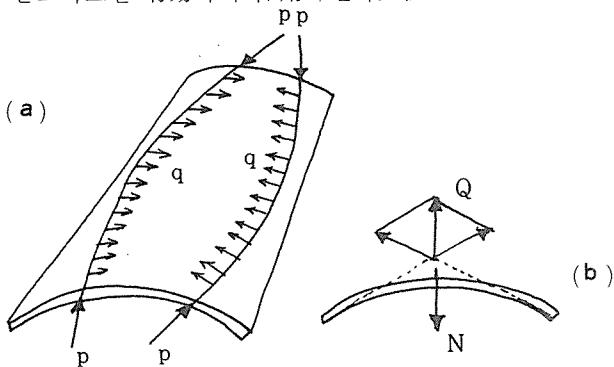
円筒形 Shell 板内에 prestress를 導入하는 方法
